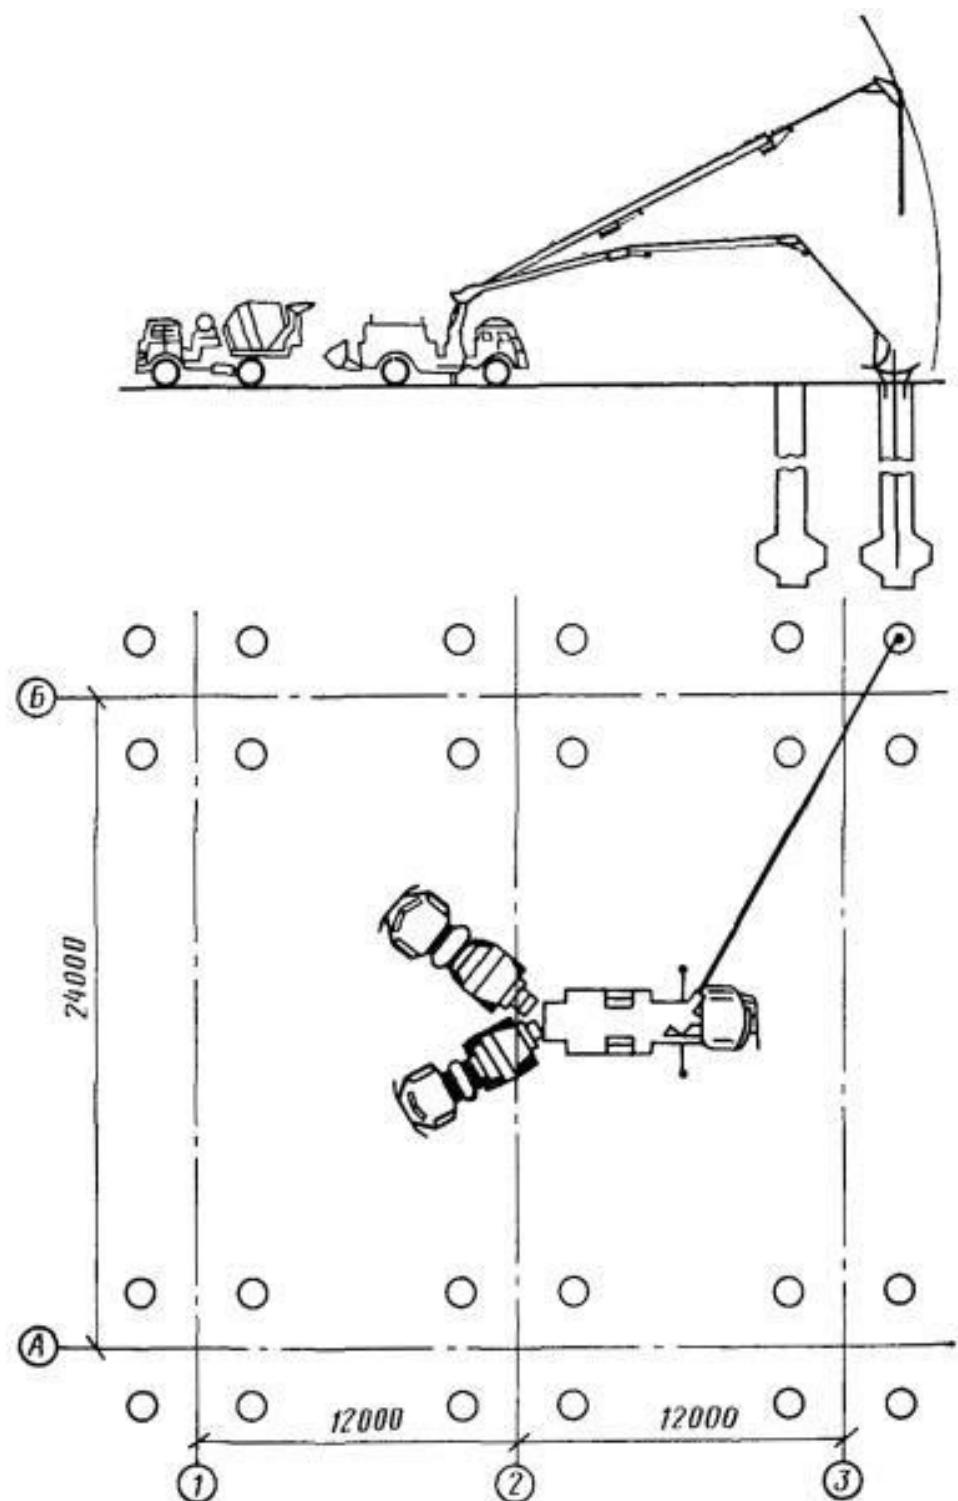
Схема бетонирования буронабивных свай напорным методом с применением автобетононасоса
